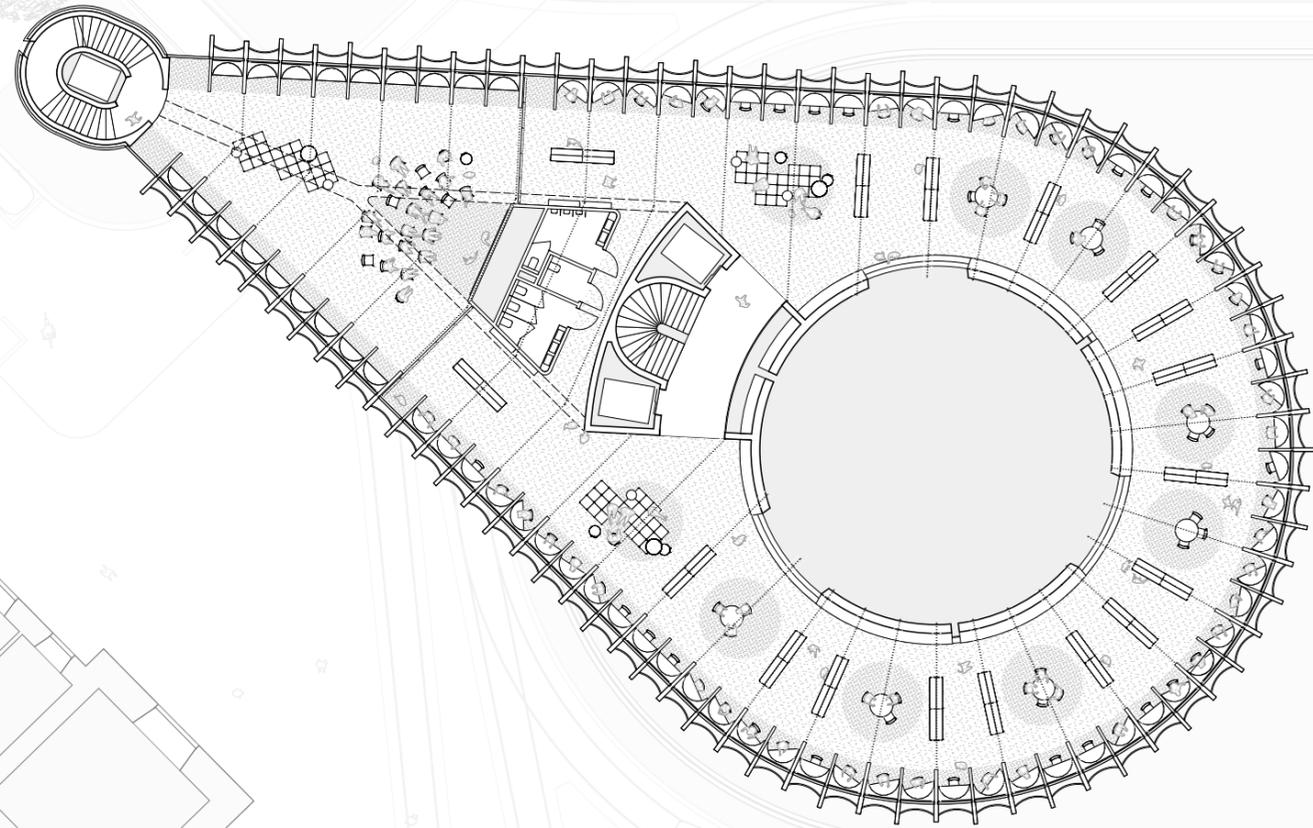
Grundriss Ebene 2, M 1:333
